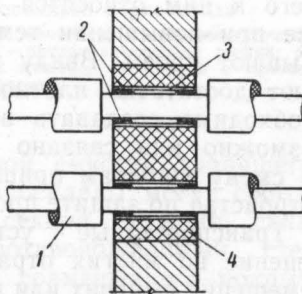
Защита отверстий при пропуске трубопроводов через стену с помощью стальных гильз и асбестовой набивки
